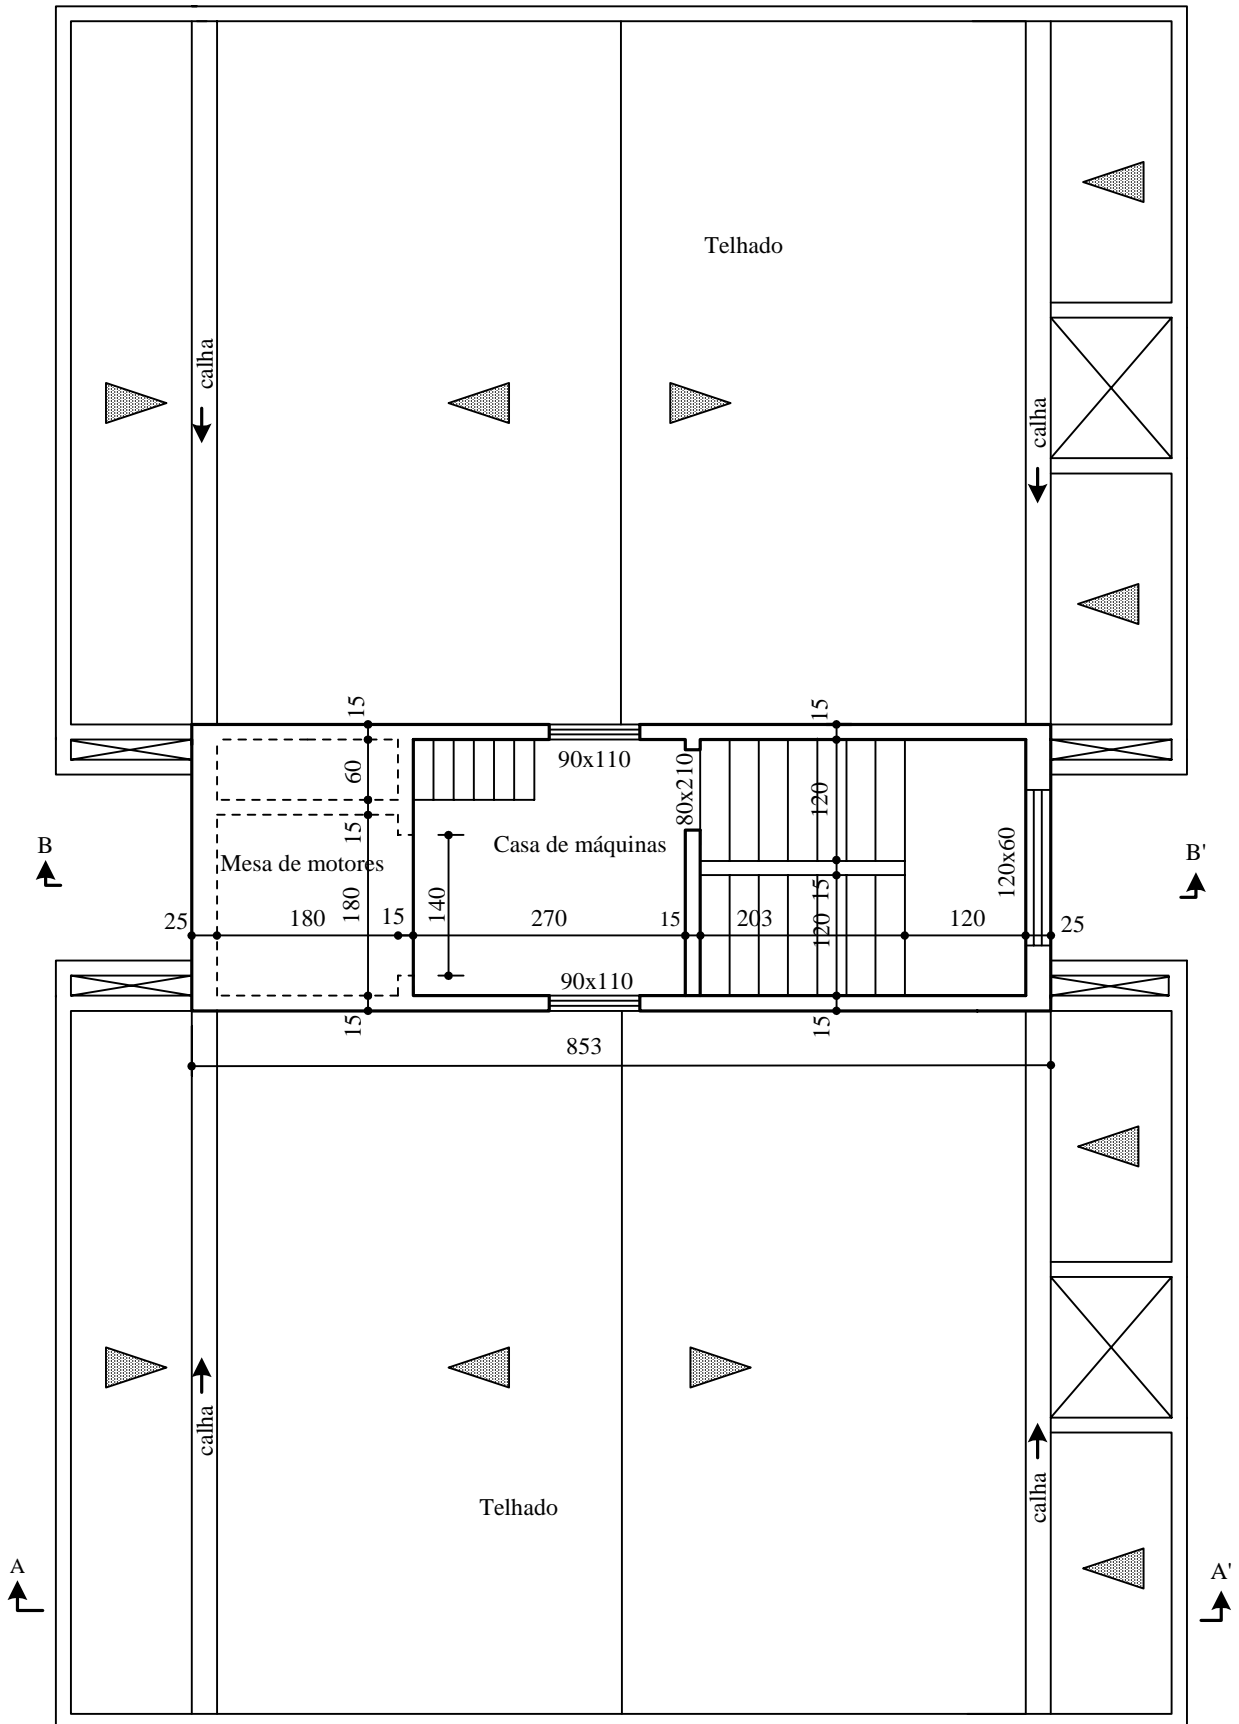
Planta baixa do telhado e da casa de máquinas
